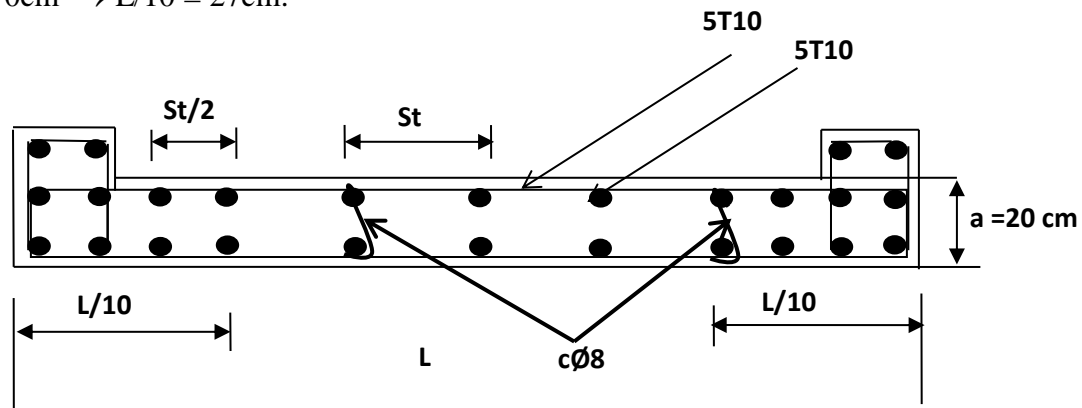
Disposition des armatures verticales dans les voiles.
